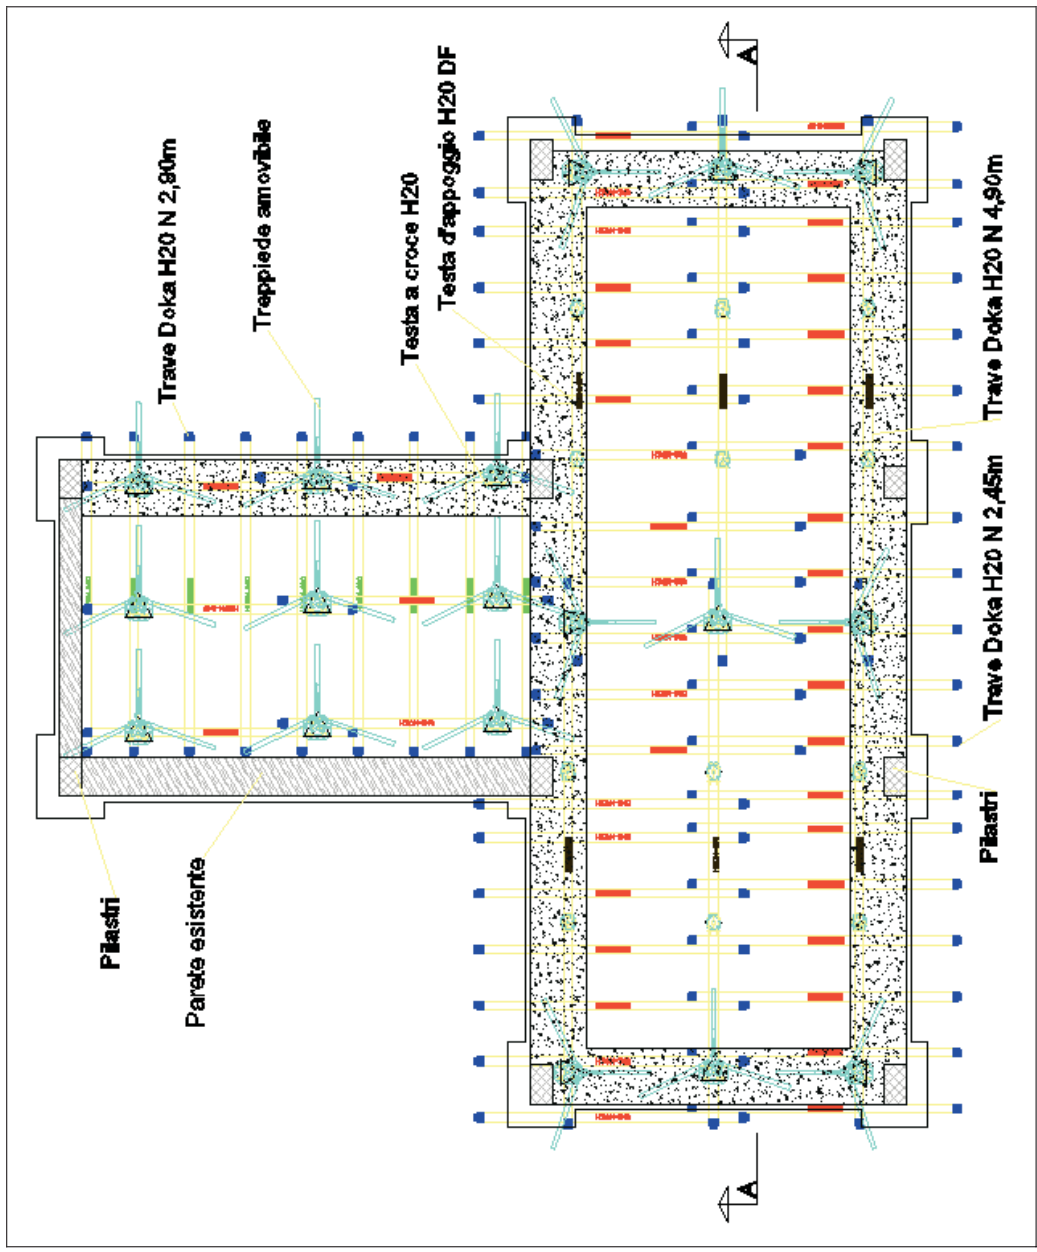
Planimetria del banchinaggio dell'orditura secondaria
